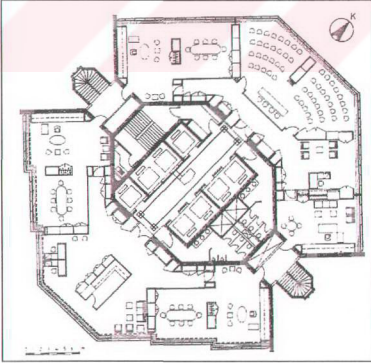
Sabancı Center (www.greatbuildings.com)[3]
